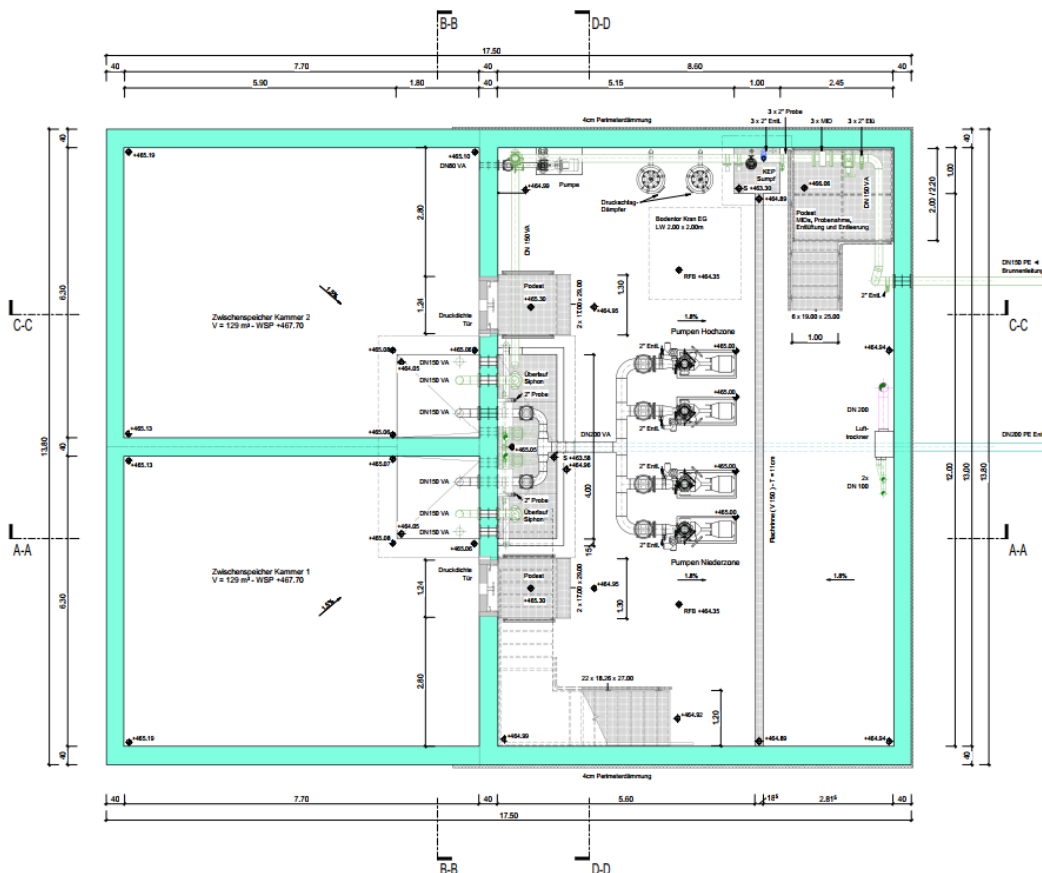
Grundriss UG/ Kammern und Pumpenkeller
